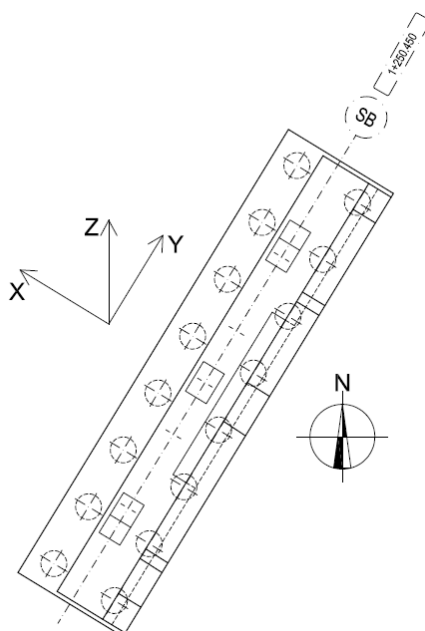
Vista in pianta della spalla: orientamento nello spazio del SdR globale del modello f.e.m.
